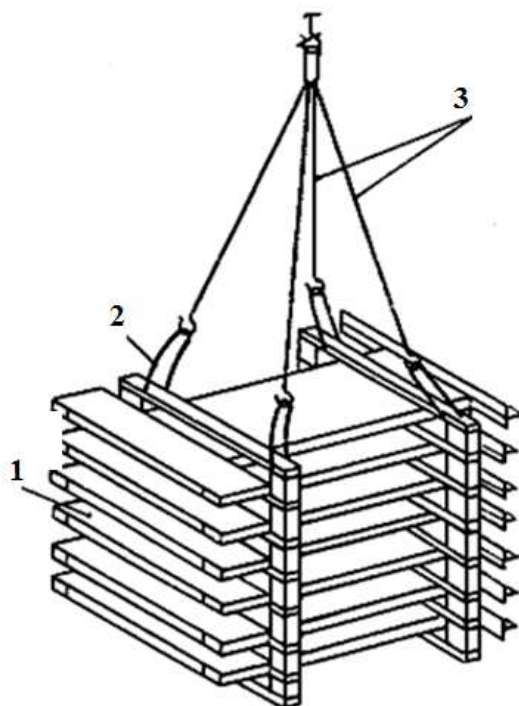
Схема строповки дверей шахты лифта в пакетах
